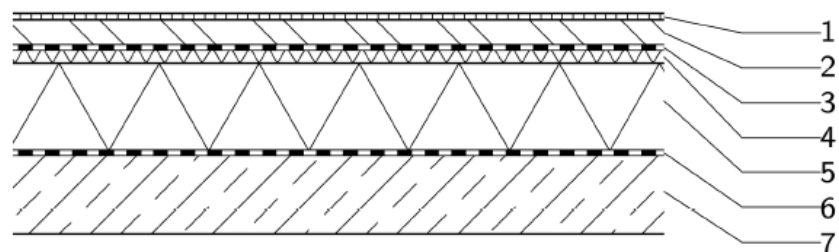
Fußbodenaufbau F02 schwimmender Zementestrich
